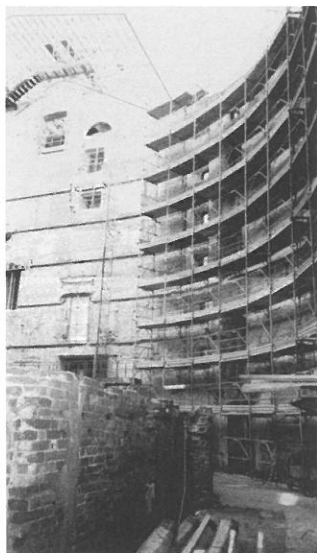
Le pareti in muratura della cavea risparmiata dall'incendio
